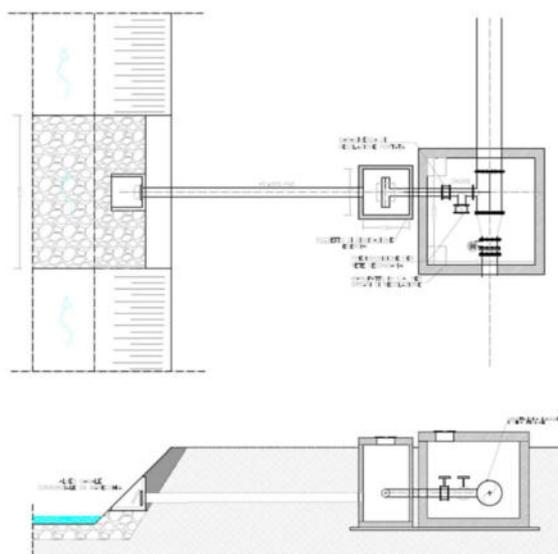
Particolare tipico nodo di restituzione al canale Dx Marecchia e predisposizione per collegamento futura rete secondaria
